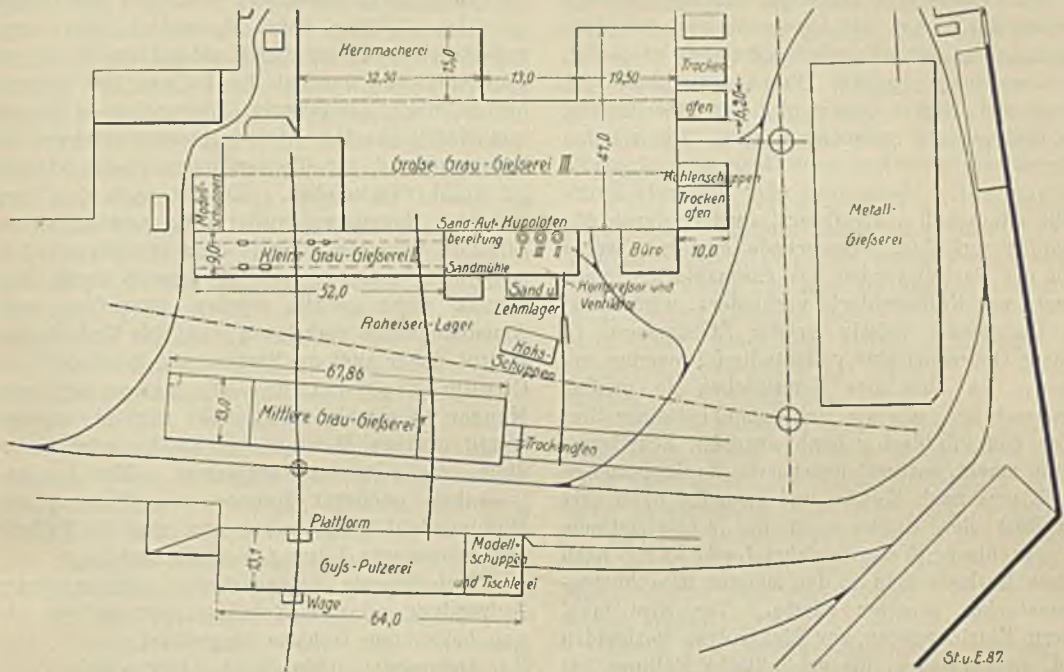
Lageplan des Nordwestlichen Fabrikteils der Skoda-Werke Akt.-Ges. in Pilsen.
